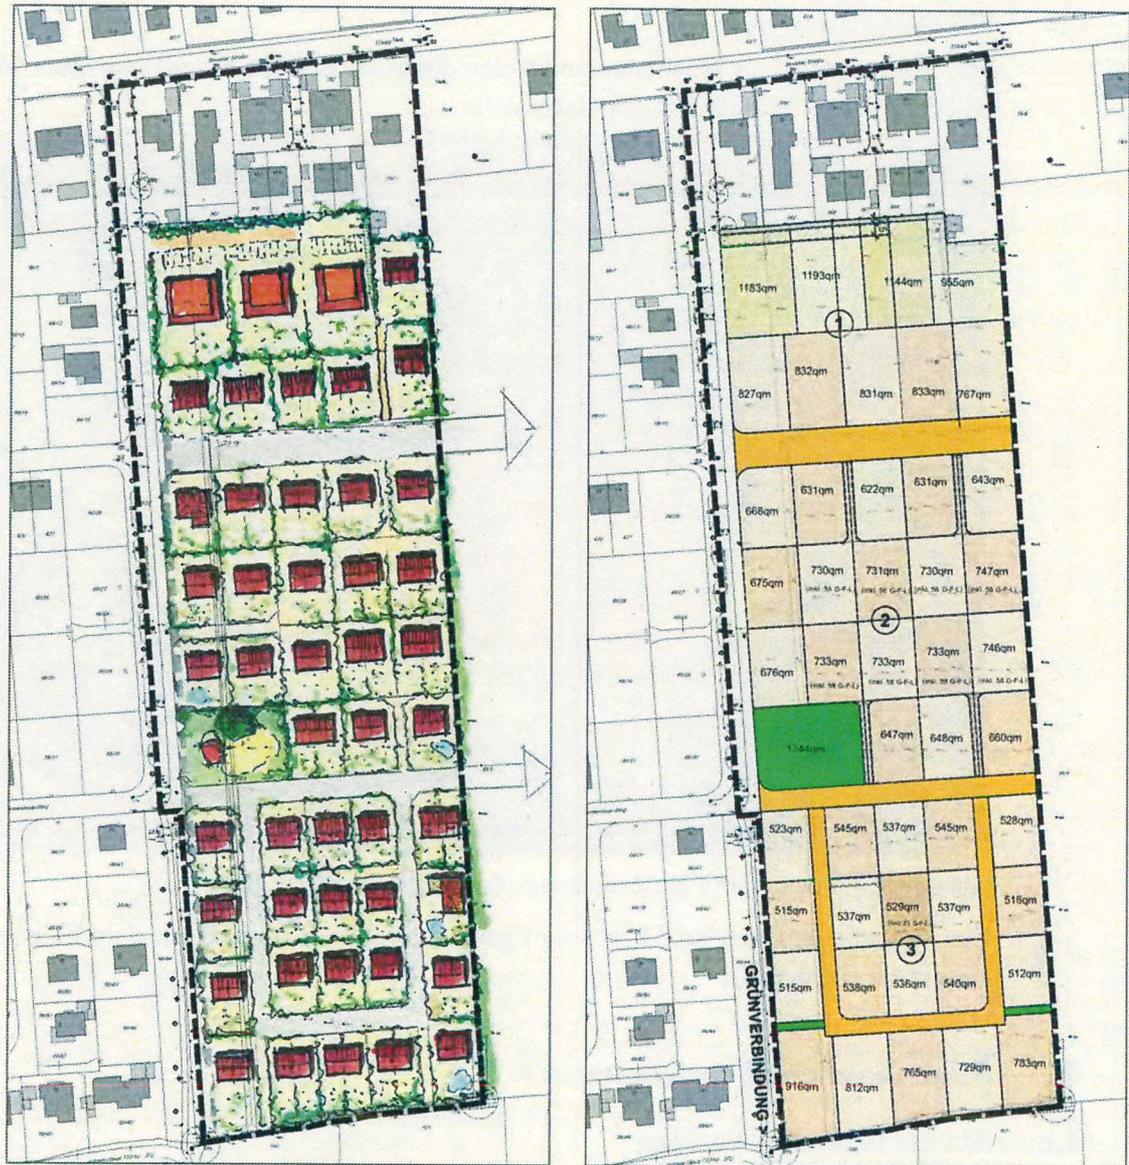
Funktionsplan und mögliche Grundstücksaufteilung
